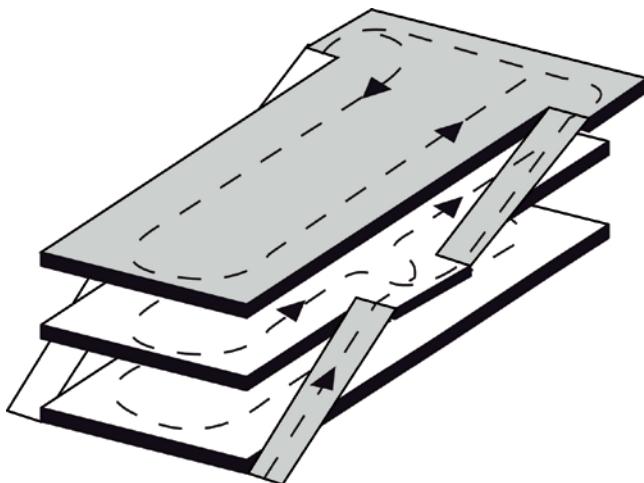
Geschossrampenanlage (Parkflächen auf den horizontalen Flächen, Rampen zur Zu- und Abfahrt) [32]
